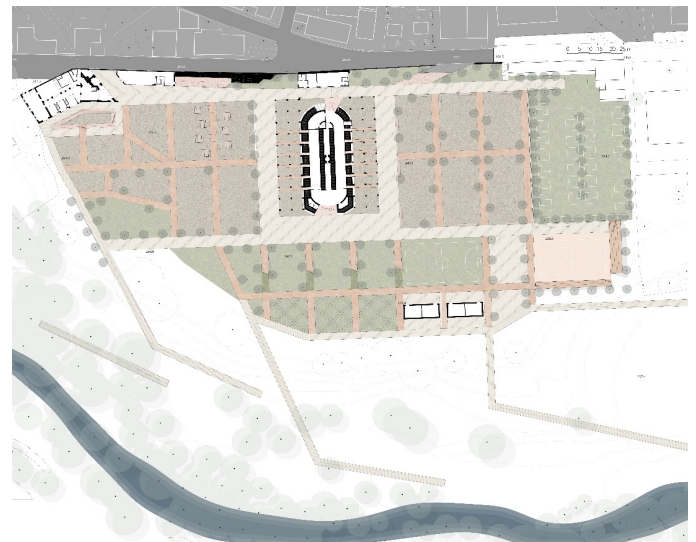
Planimetría de la propuesta de proyecto del espacio público.
